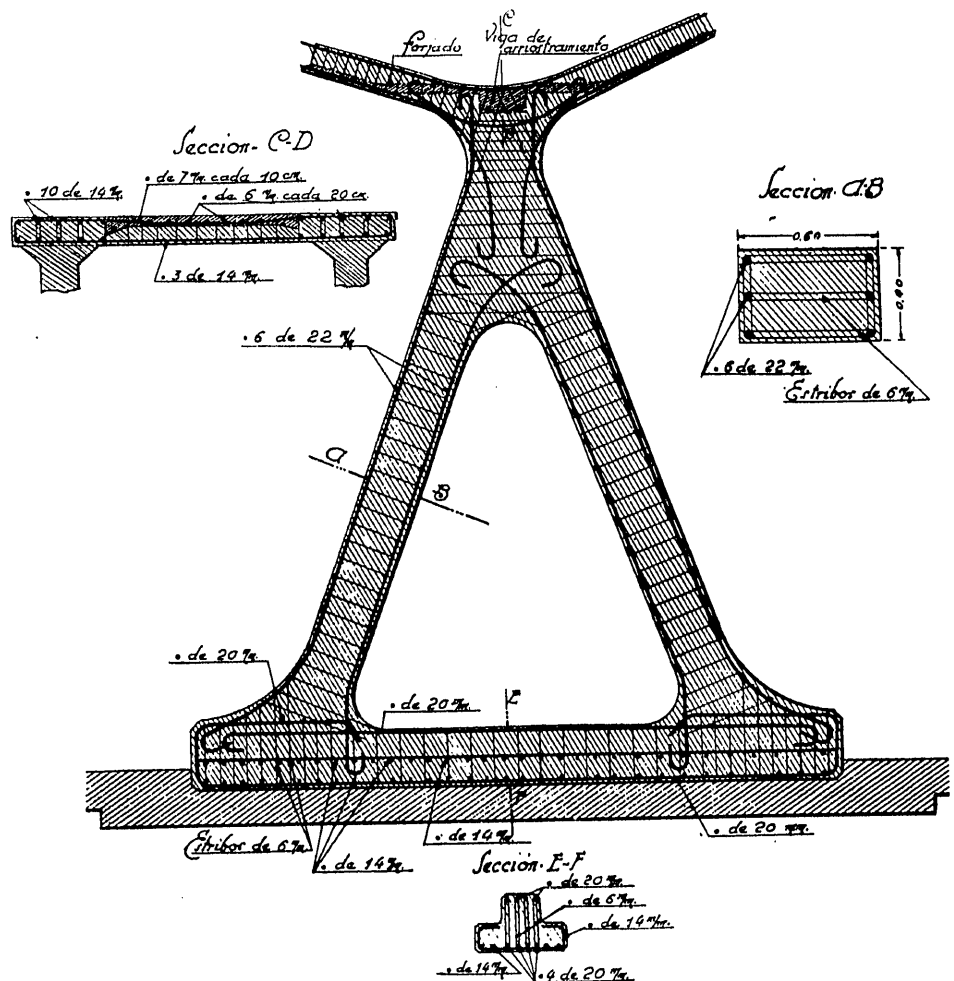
ª Pila semiestribo. Corte transversal y secciones
